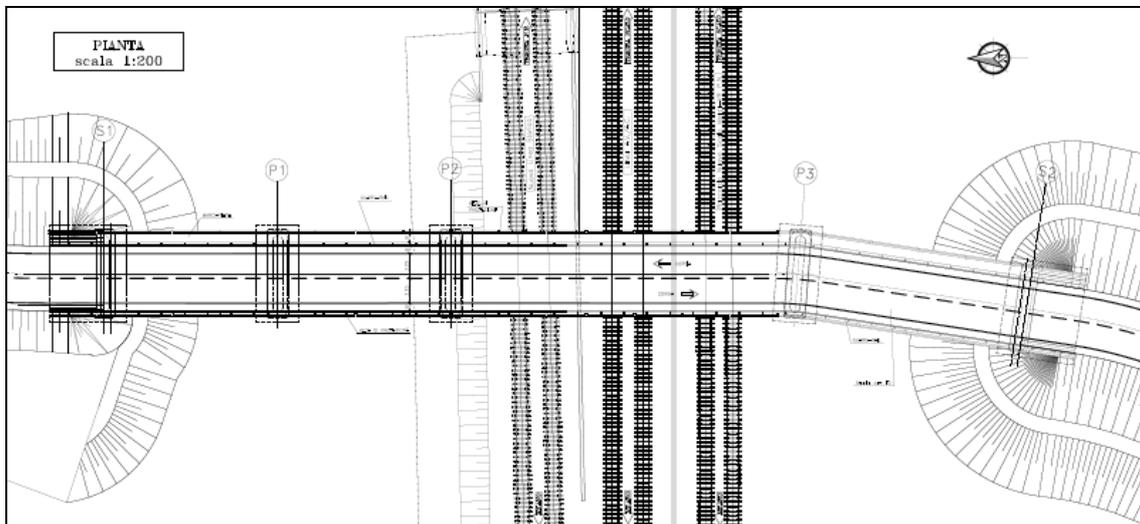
Cavalca-ferrovia Via Fenilon – Pianta 1:200
